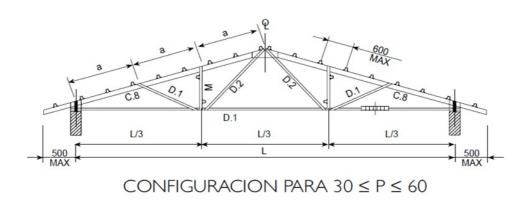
Configuración tipo de cercha para pendiente entre 30° y 60°
